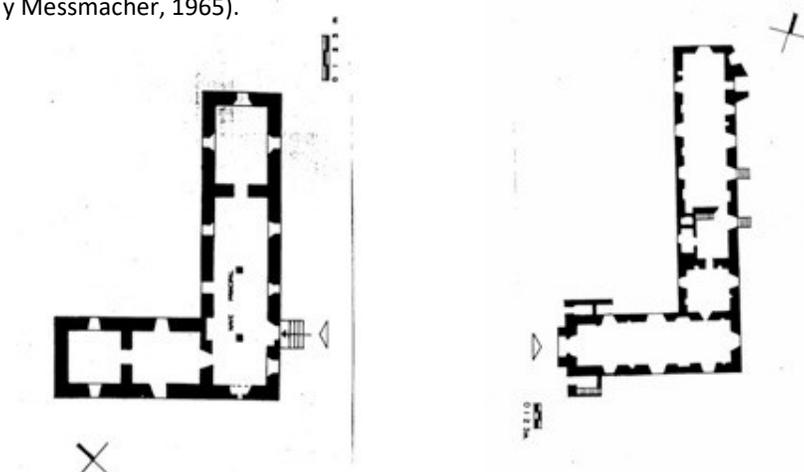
Ejemplos de las plantas arquitectónicas de las misiones de Santa Gertrudis y Santa Rosalía. Fuente: El estilo arquitectónico de las misiones de Baja California de Diana Guerrero González y John Joseph Temple Sánchez
